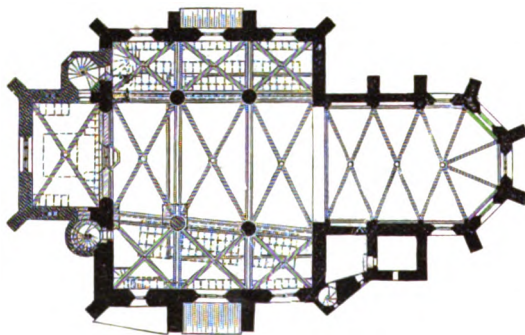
Pfarrkirche in Mögeldorf. Grundriss.
